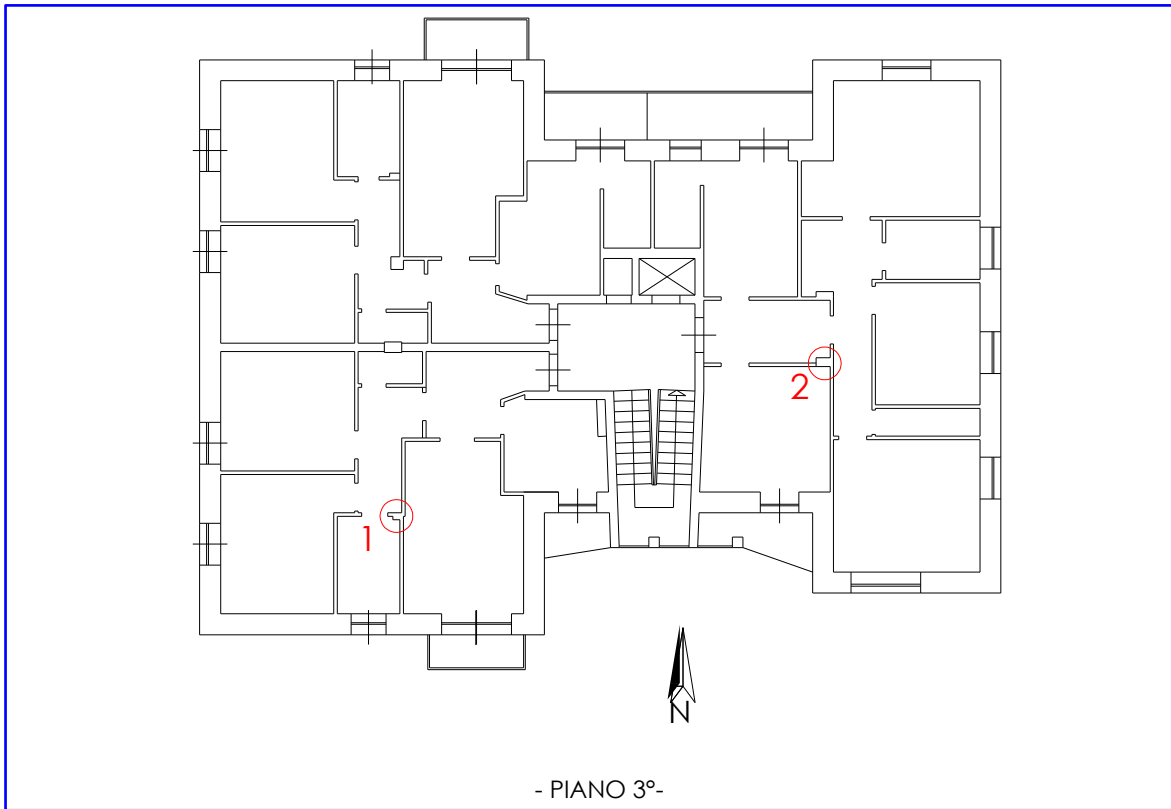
Planimetria del piano terzo (L3) con l'ubicazione delle zone esaminate
